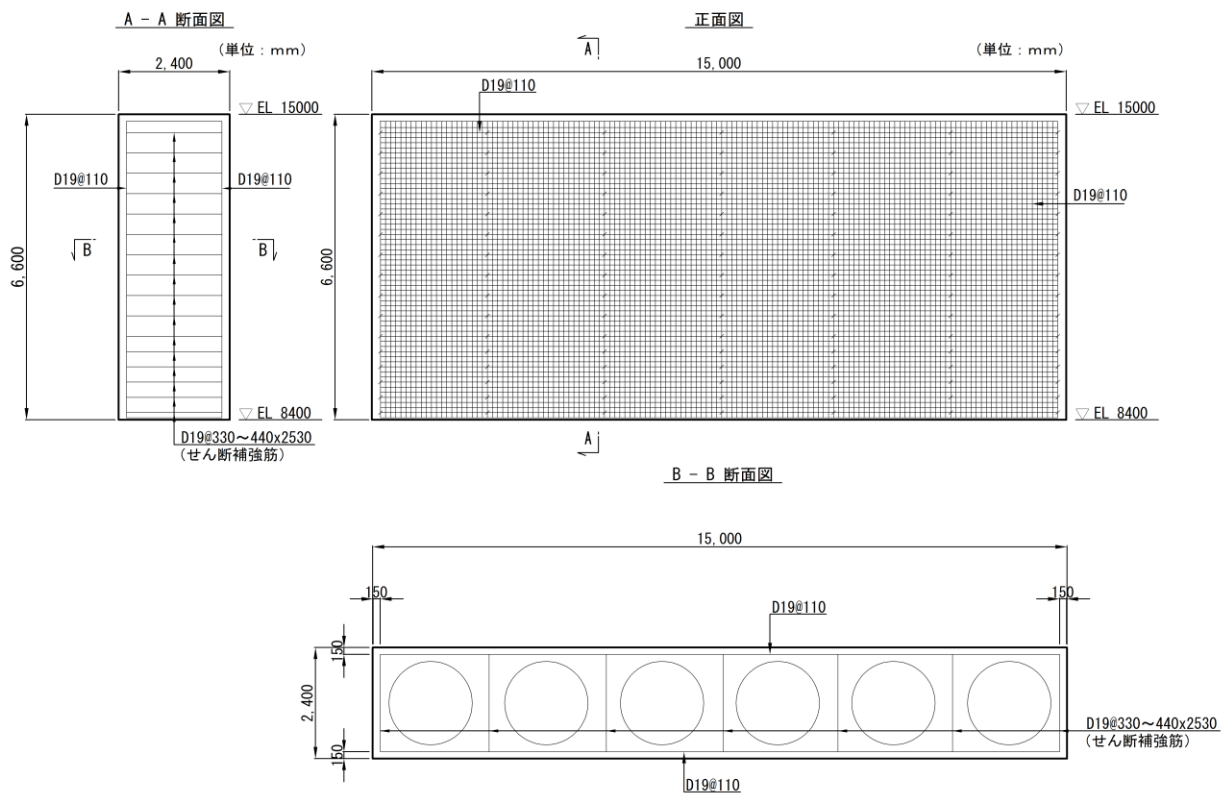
被覆コンクリート壁の概略配筋図 (②-②断面)
